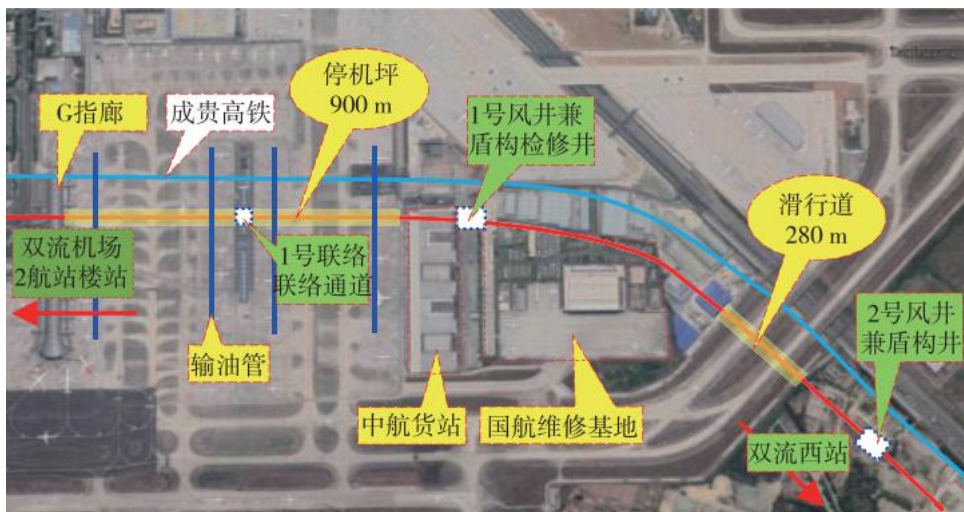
地铁 10 号线穿越工程线路平面示意
